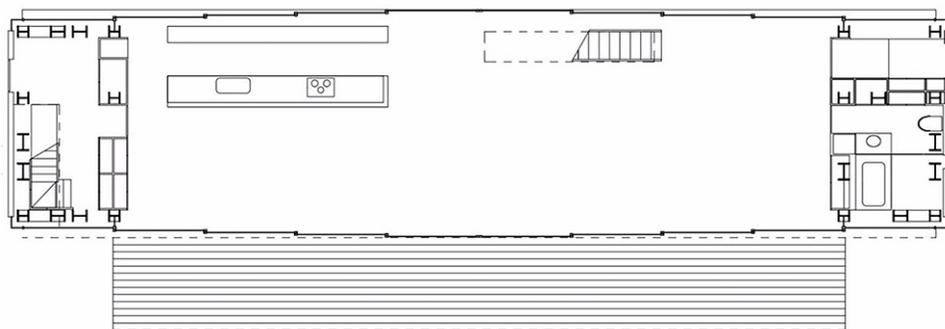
Picture Window House - Planta Baja. Elaboración: Shigeru Ban Architects
